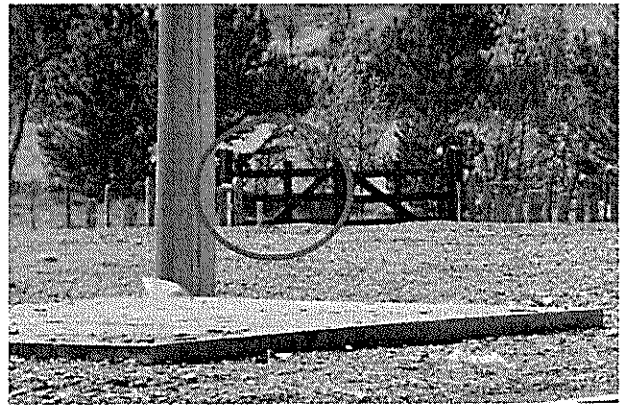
Detalle Fisuras y grietas en pavimento.
